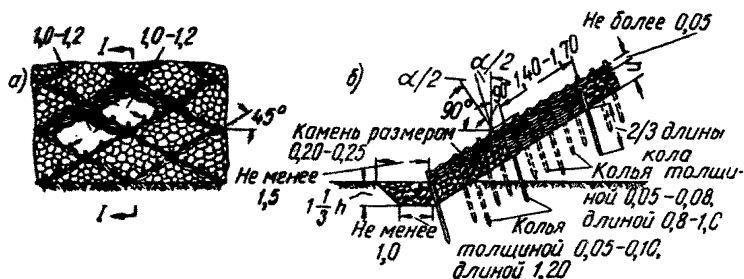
Укрепление откоса насыпи или бермы каменной наброской в плетневых клетках
